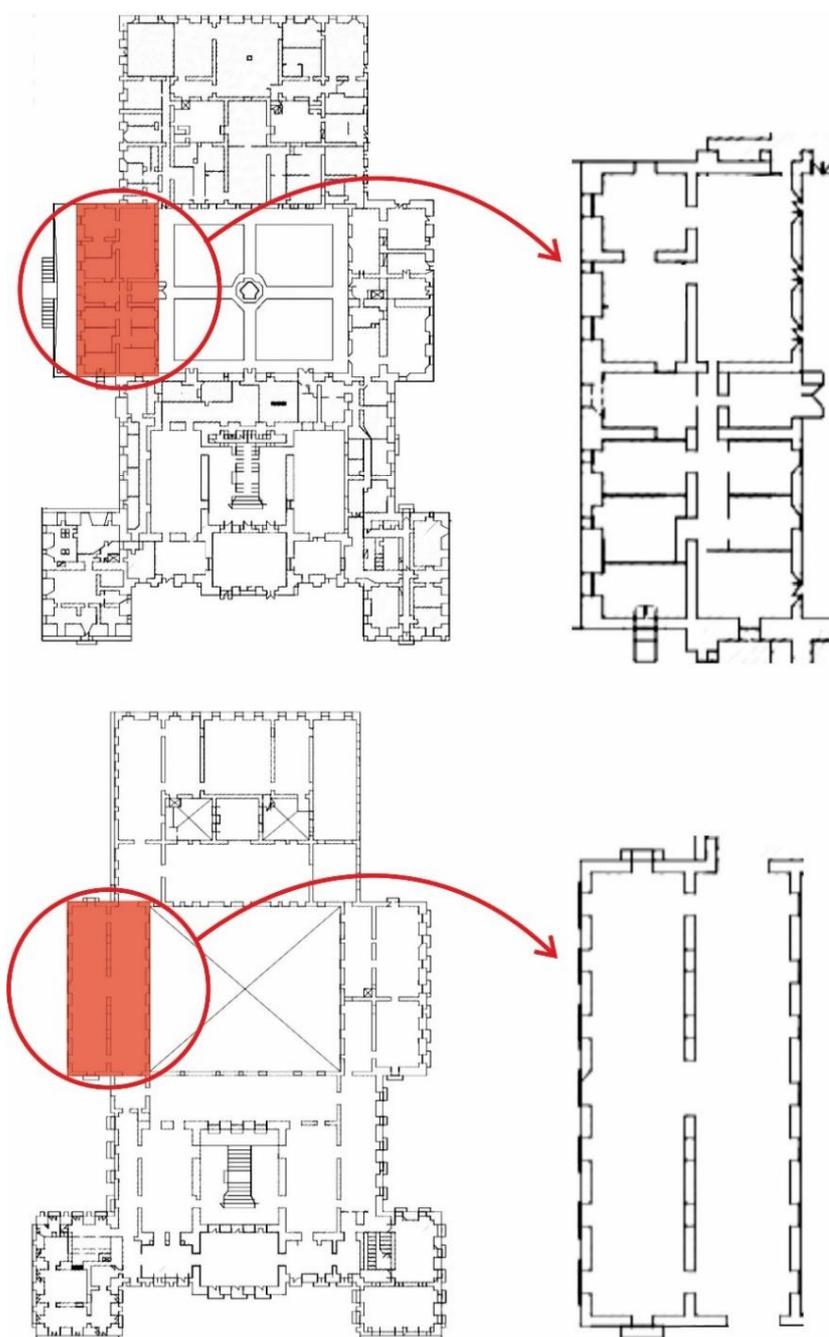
Em cima, a planta Baixa do 1º pavimento e, embaixo, a planta baixa do 2º pavimento do PSC, com detalhe ampliado do bloco II.
